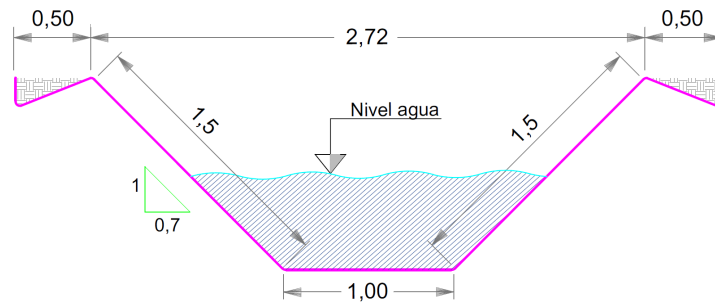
Sección Propuesta para Revestimiento de Canal (Fuente Propia)
